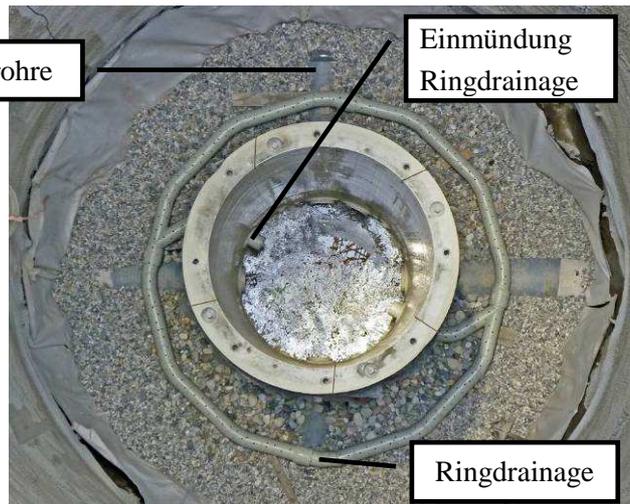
Schachtneubau mit Ringdrainage und kornabgestufter Drainagekiesverfüllung
